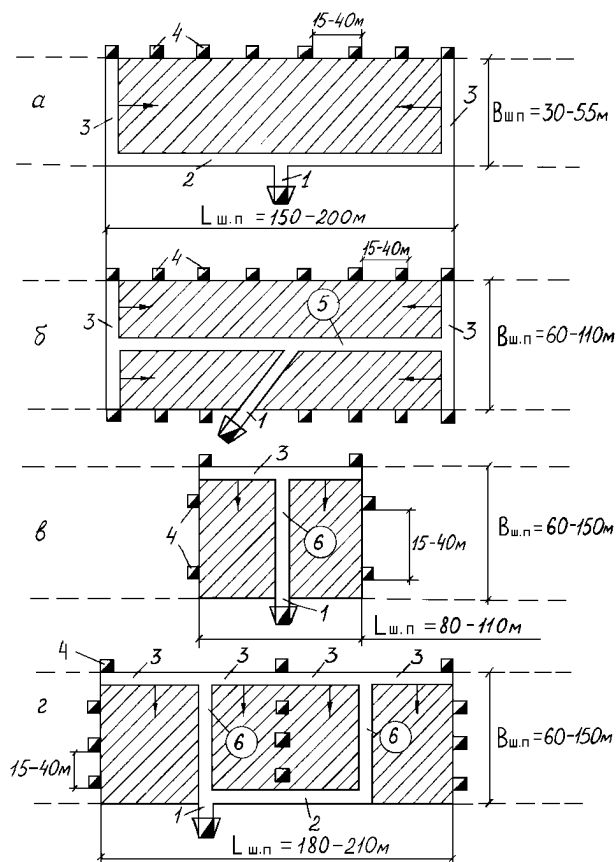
Схемы подготовки по пласту с пограничными вентиляционными шурфами для узких (а) и средней ширины (б - г) россыпей:
